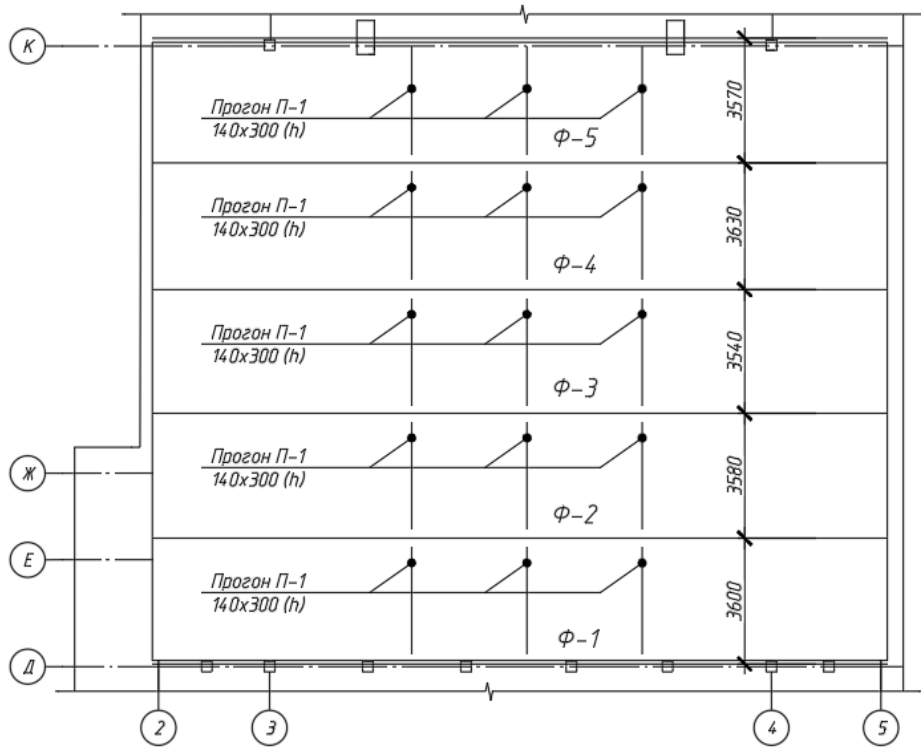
Схема розташування залізобетонних монолітних ферм покриття в осях 2-5/Д-К
